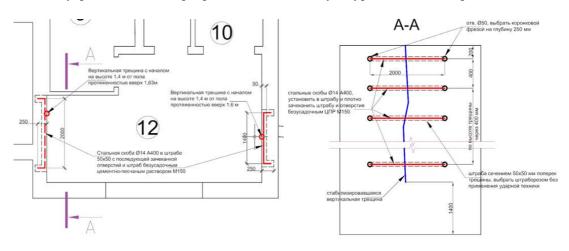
Рекомендованная схема усиления стен с трещинами установкой стальных скоб
